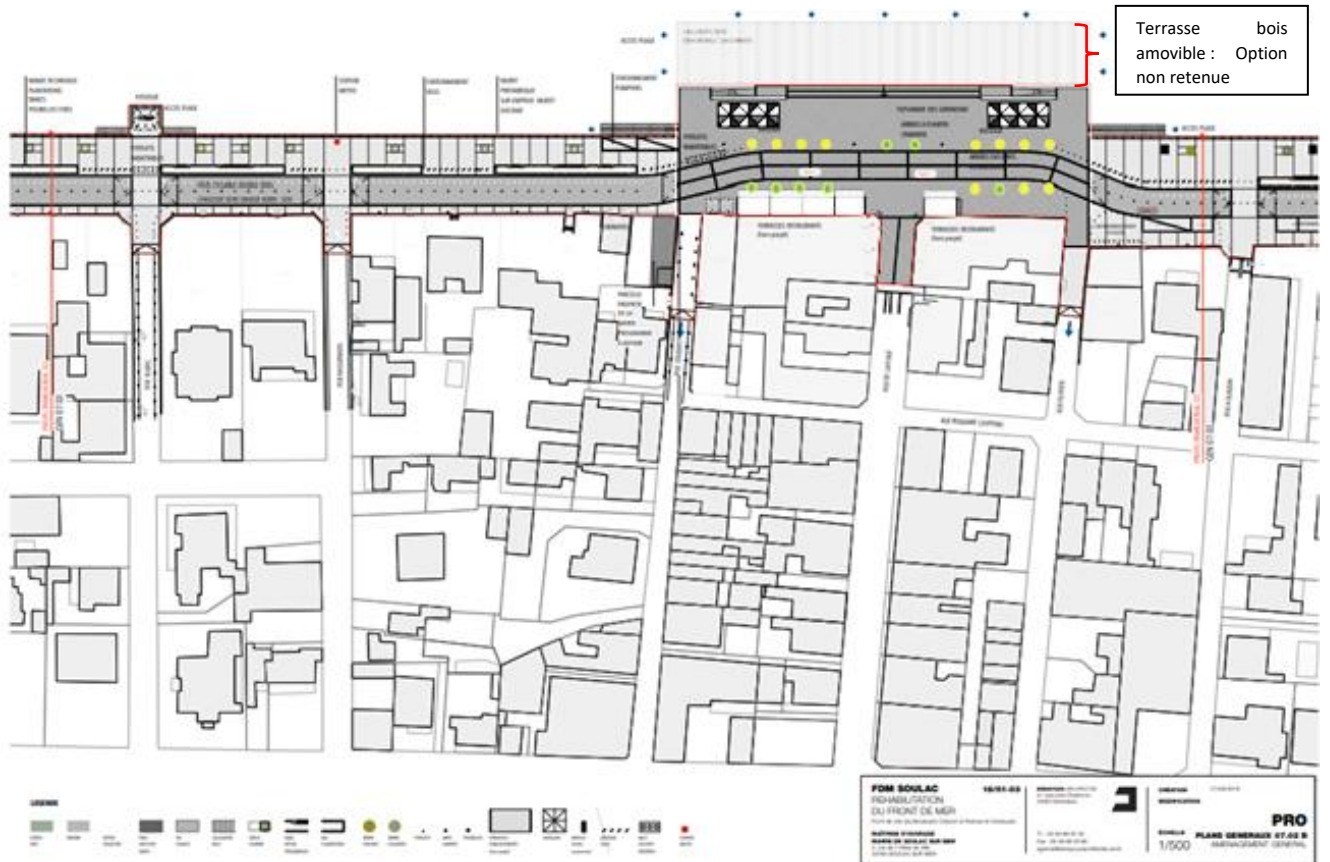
Plans de l'aménagement projeté (portion 2) (Source : PRO –juin 2018)
